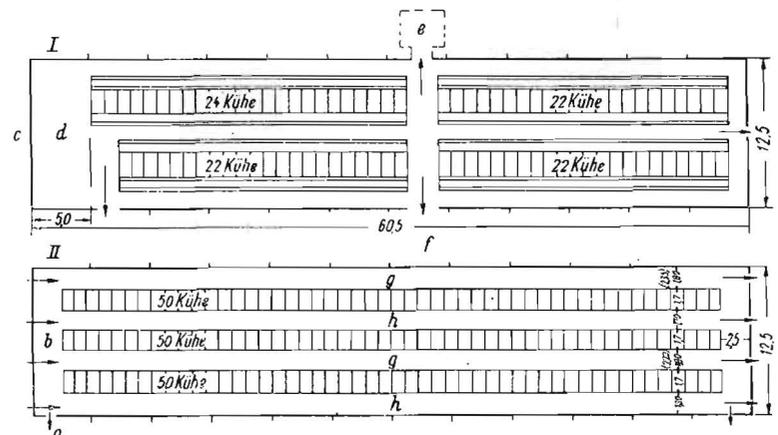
Zwei- und dreireihige Kuhställe in Skelettbauweise für Gebiete mit Weideaustrieb. I Grundriß: 2reihig, Mittellangstand. a Milchhaus mit Melkständen, b Futterterrasse, unabhängig vom Stallgebäude, c Milchräume, d Futterterrasse, e Milchhaus (angebautes Milchhaus oder am Giebel eingebaute Milchräume), f angebautes Milchhaus mit Melkständen, g Durchfahrtsfüttergang, h Durchfahrtdunggang. II Grundriß: 3reihig, Kurzstand
